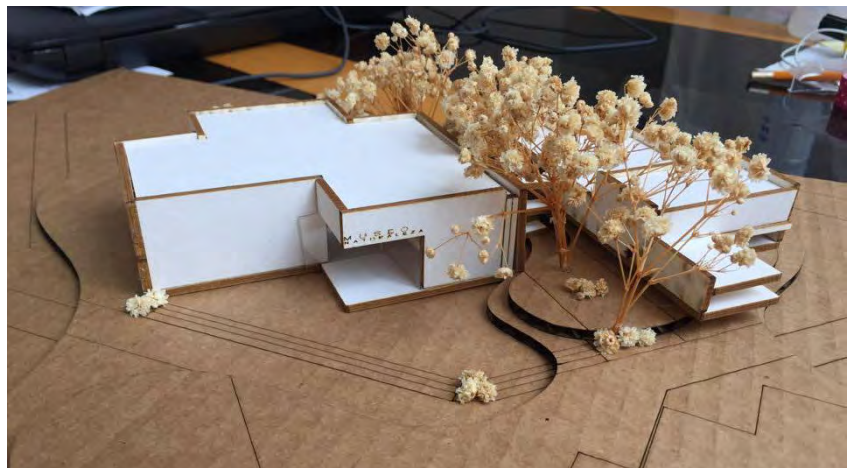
Maqueta del edificio, vista Norte-Sur en perspectiva del edificio.
